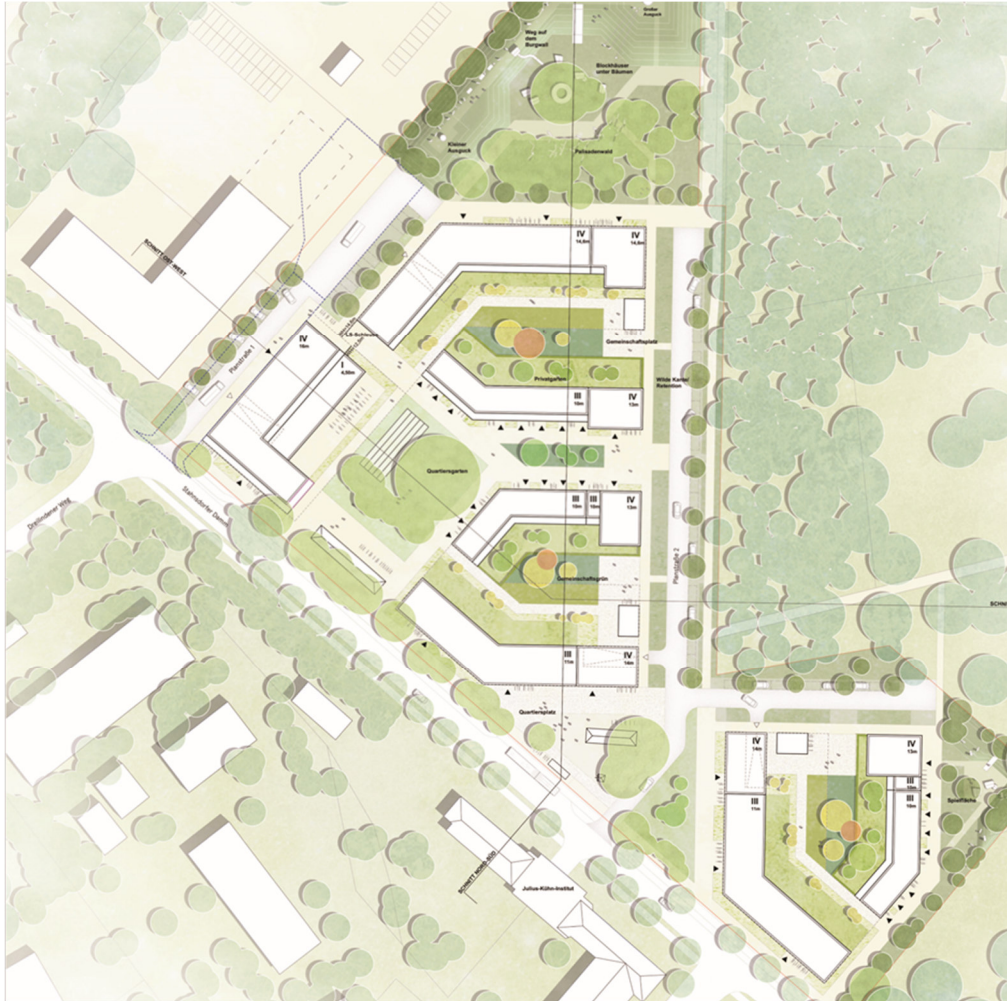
Lageplan Städtebaulicher Entwurf (TeleInternetCafé / Treibhaus Landschaftsarchitektur)
